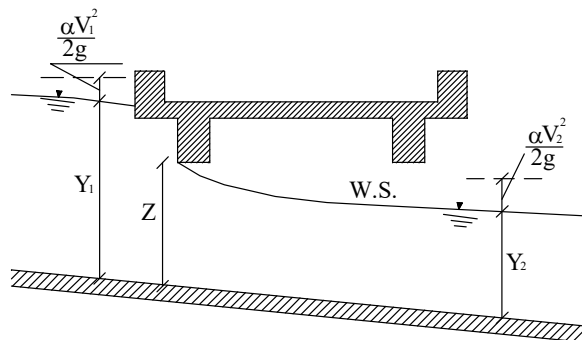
Sezione schematica di un ponte – Schema di calcolo
